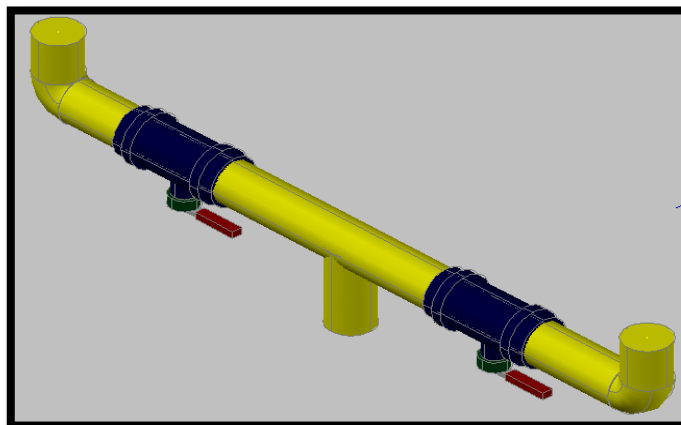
Tubería de PVC con llave de paso<sup>68</sup>
